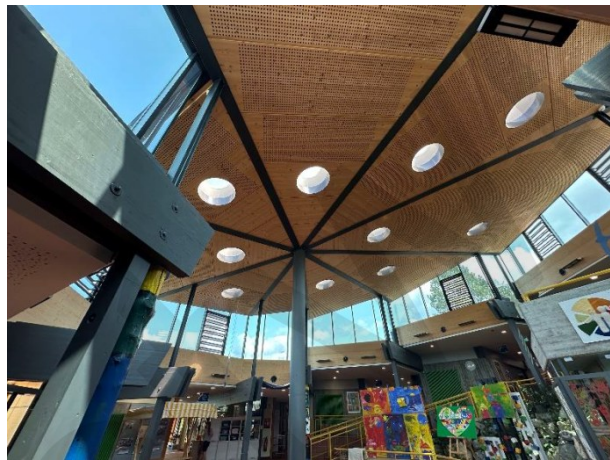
| Exemplarische Ansicht der Dachkonstruktion (Auladach)
